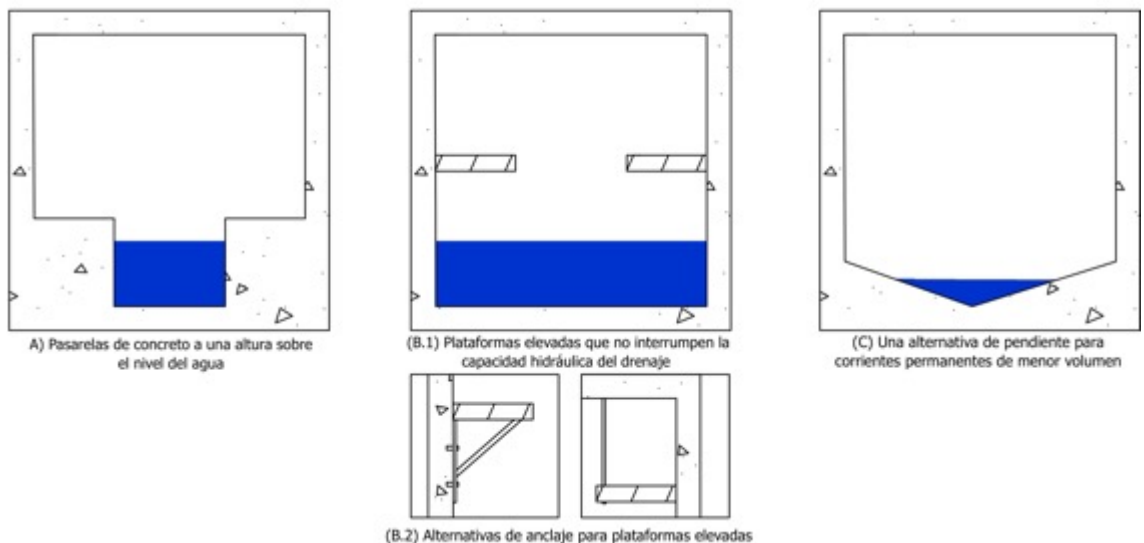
Secciones transversales de estructuras de drenajes para el paso de fauna.
